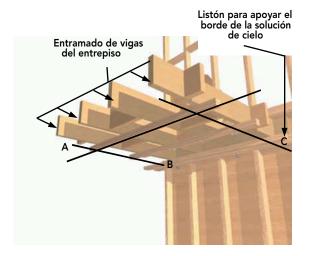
17: Las tres rectas (A, B y C) pertenecen al plano horizontal determinado por el listoneado.
